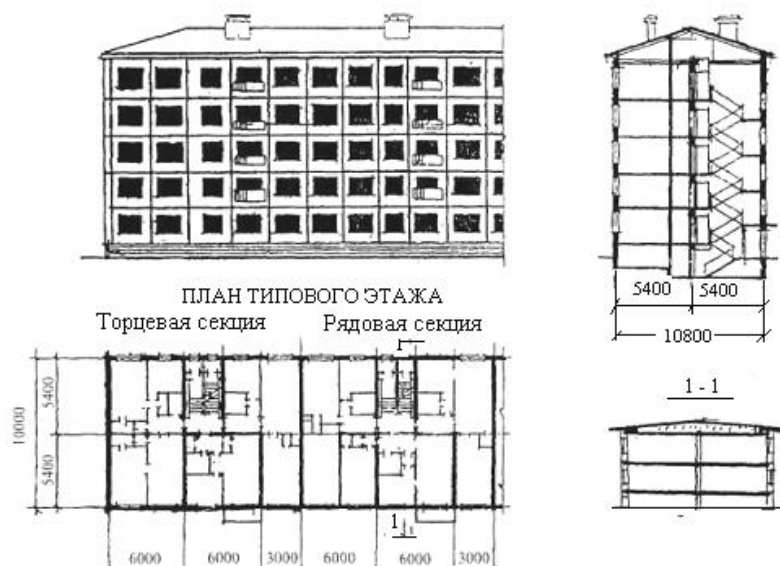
Фасад, план типового этажа и разрез крупнопанельного жилого дома серии1-468
